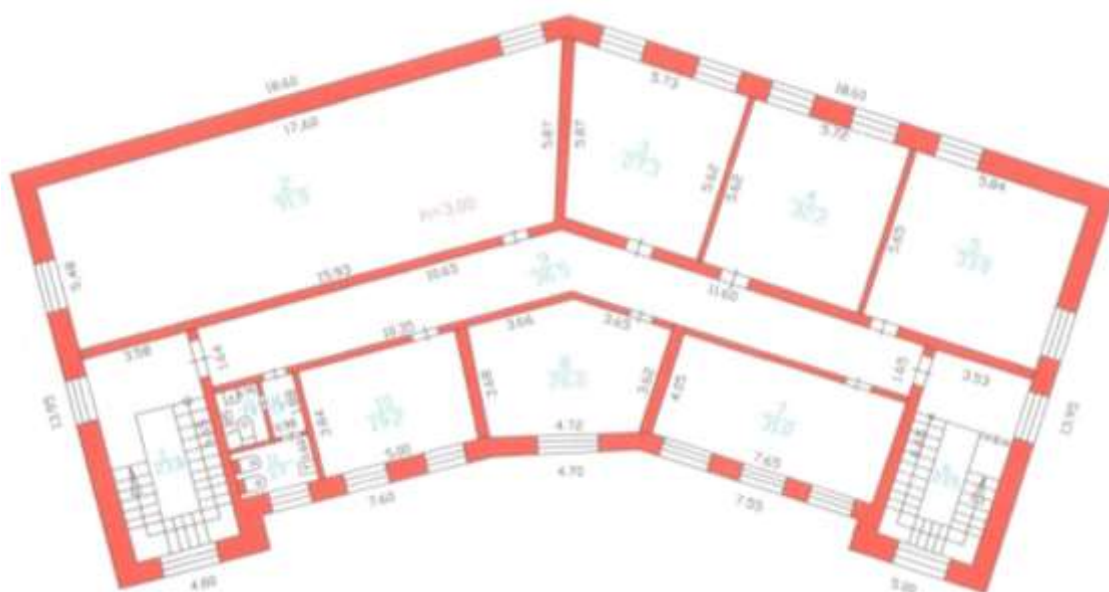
План 2 этажа здания поста ЭЦ
